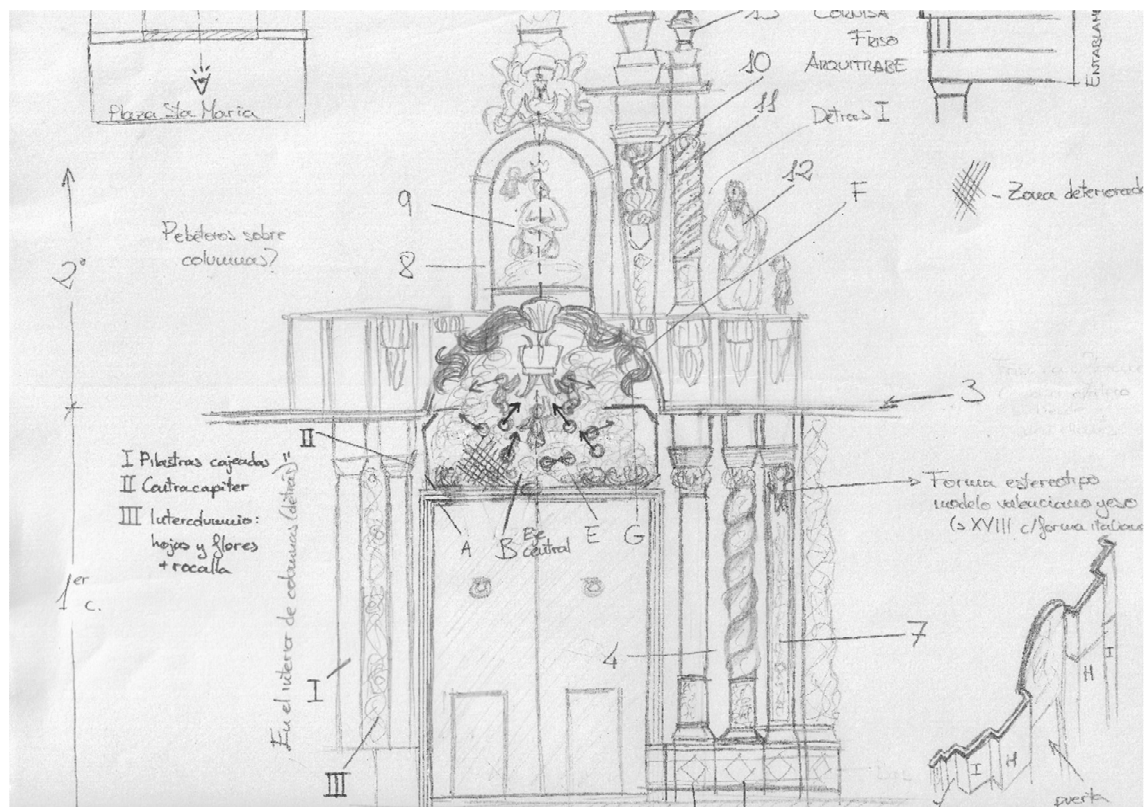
Croquis con los elementos de la portada central de la fachada Sur. 2020
